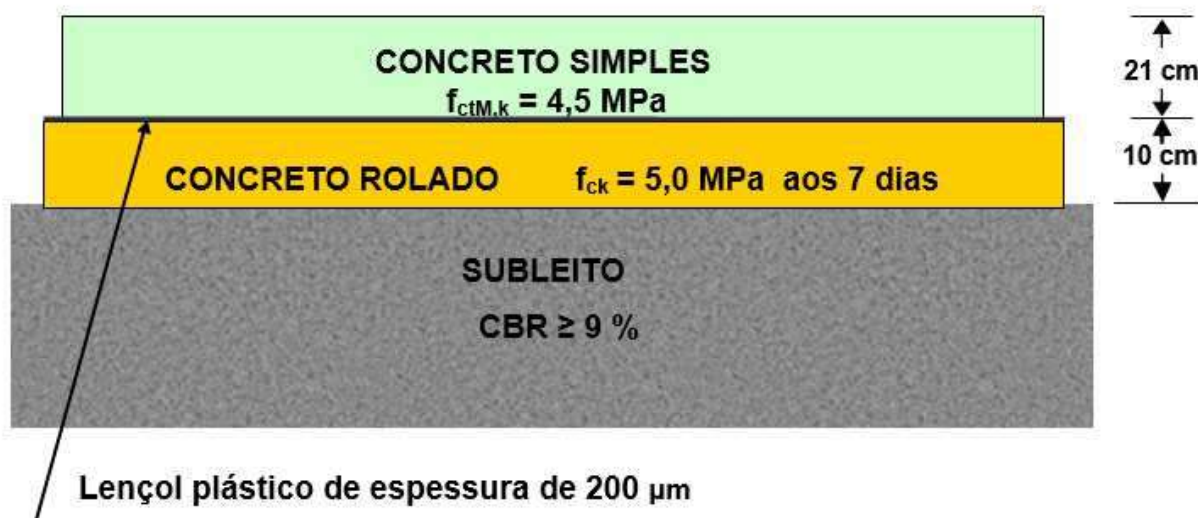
Estrutura de pavimento rígido da Avenida Comercial.
